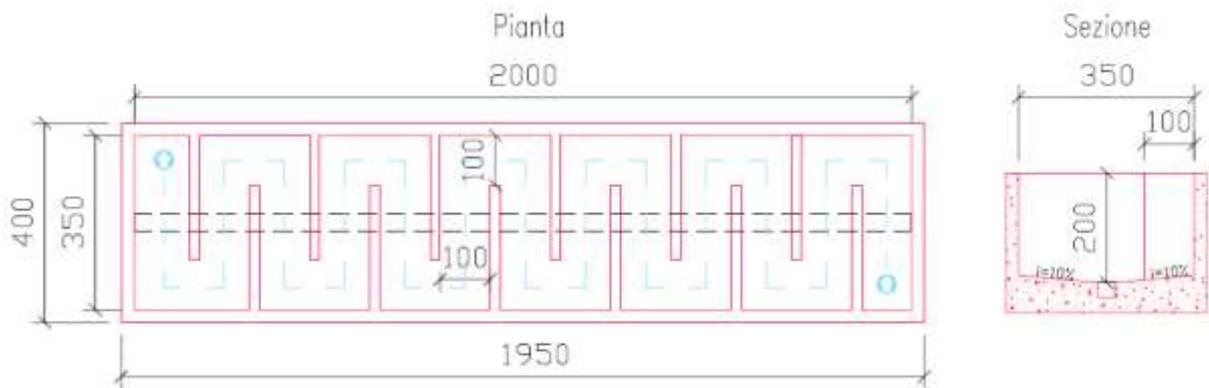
Pianta della vasca di decantazione (quote in cm)
